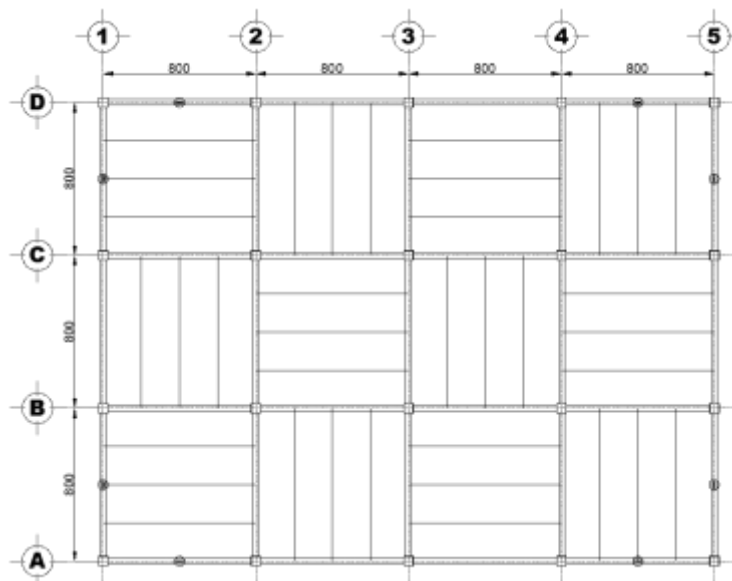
Planta estructural (tipo) de edificio de oficinas
